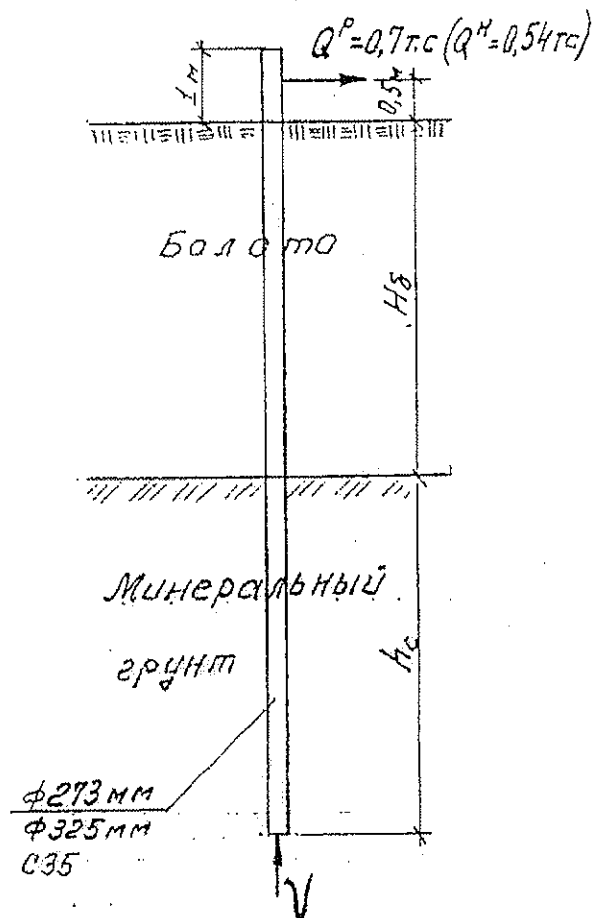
Расчетная схема сваи для опор анкерного типа в нормальном режиме (восемь свай на одну опору)
